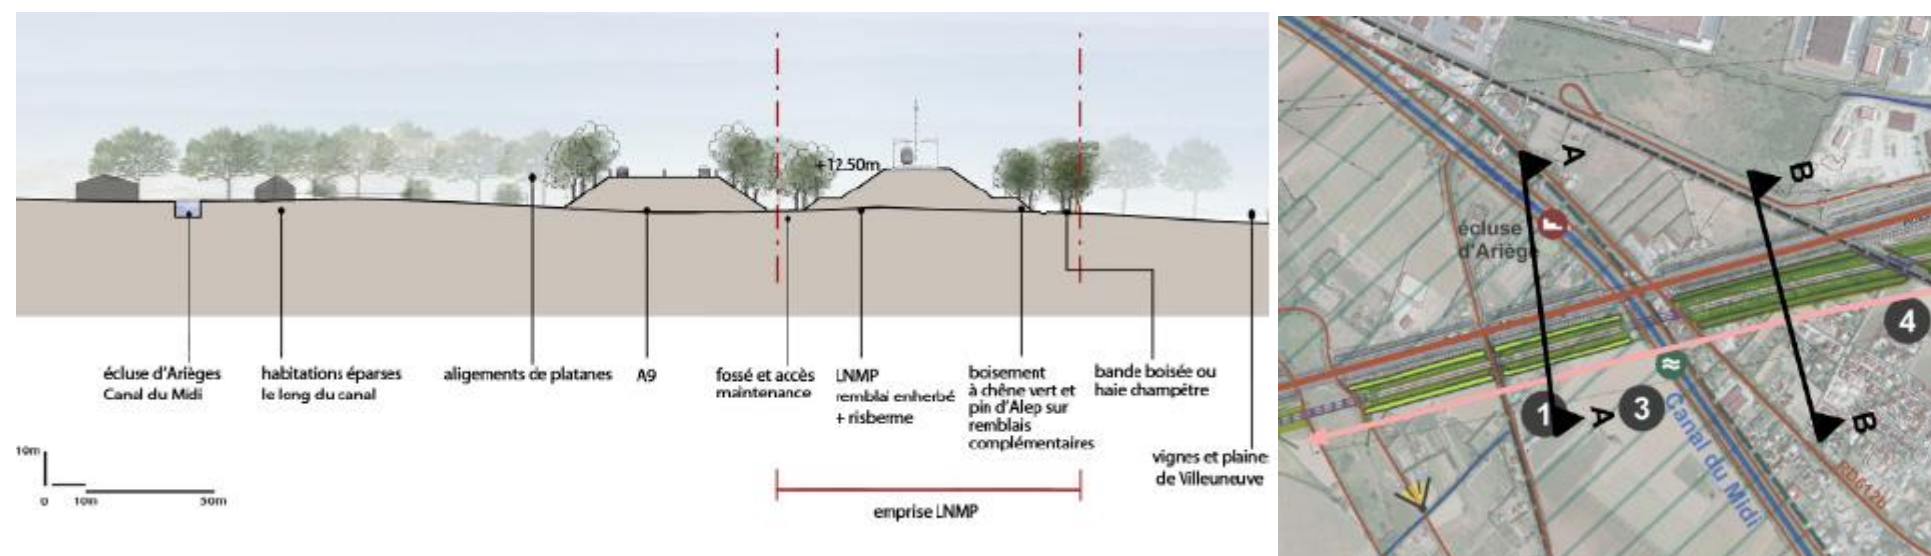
profil en travers du projet à proximité de l'A9 – coupe AA (source : Traverses)
